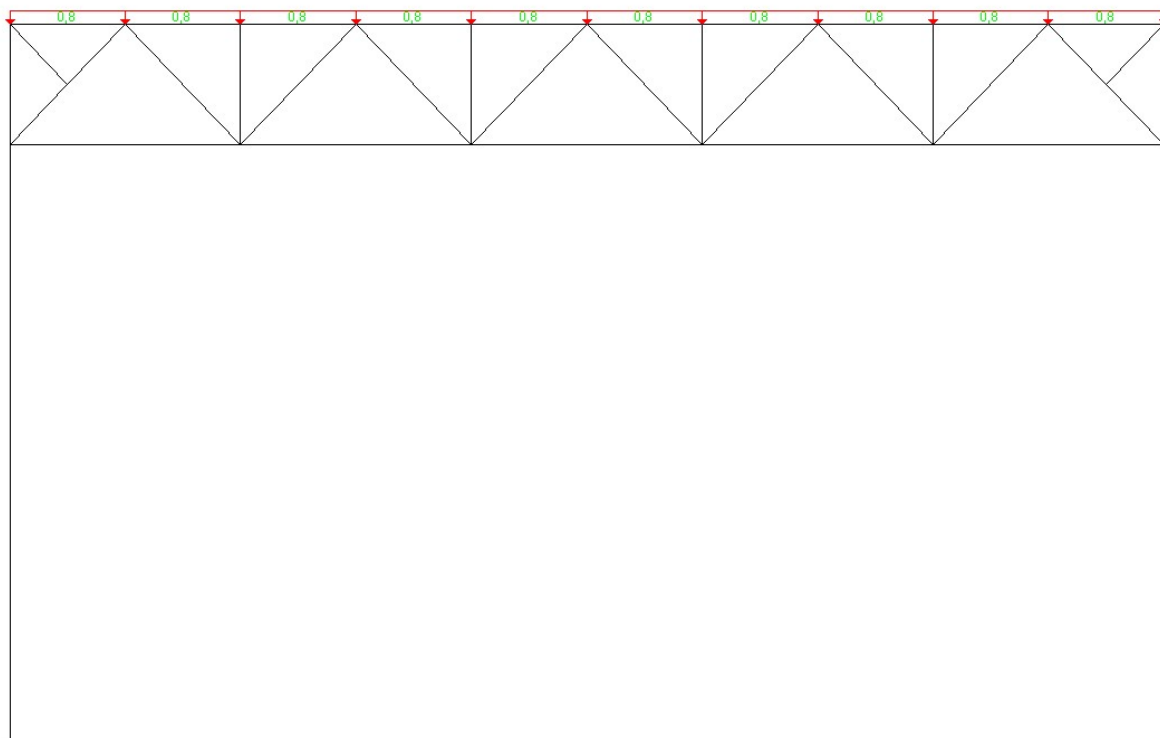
Схема приложения нагрузки от покрытия на раму [11]
